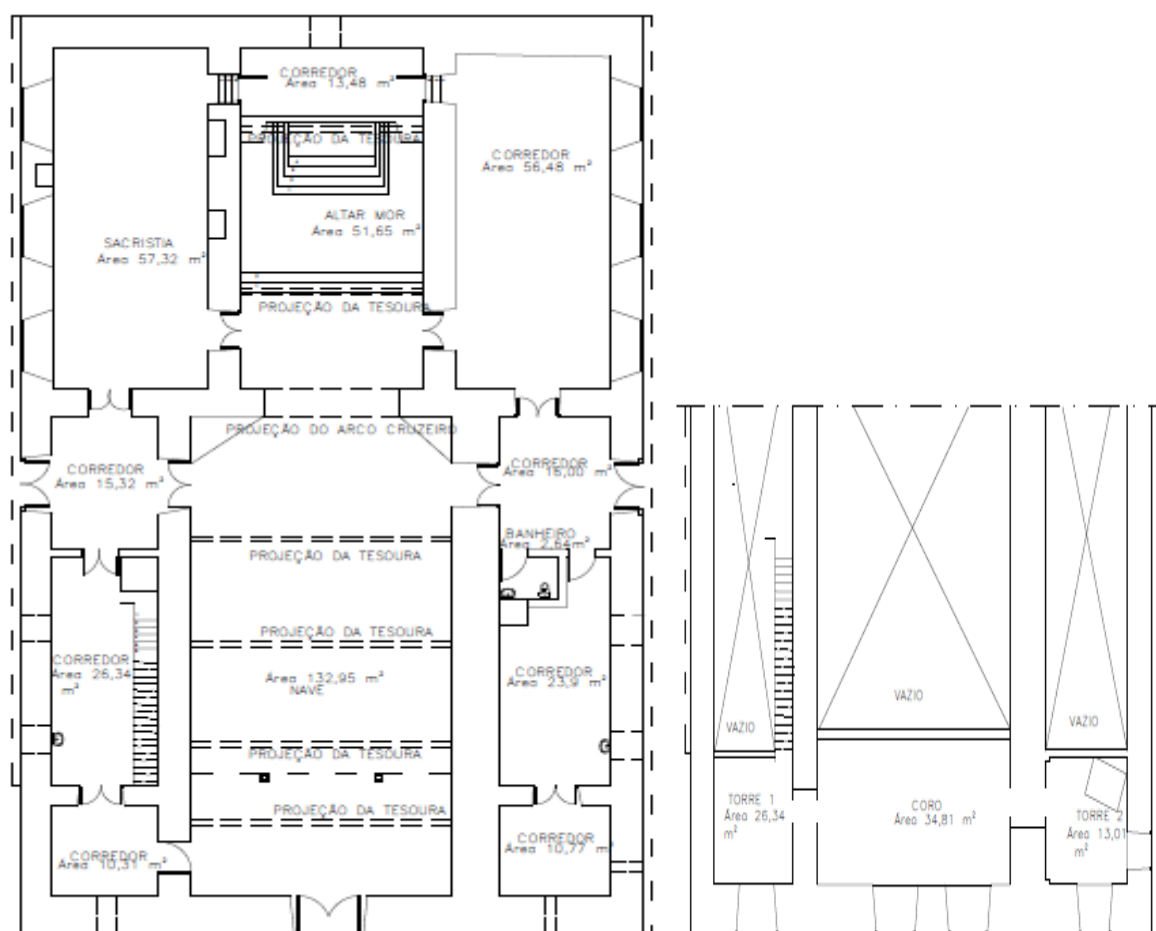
Planta baixa do 1º pavimento e 2º pavimento.
